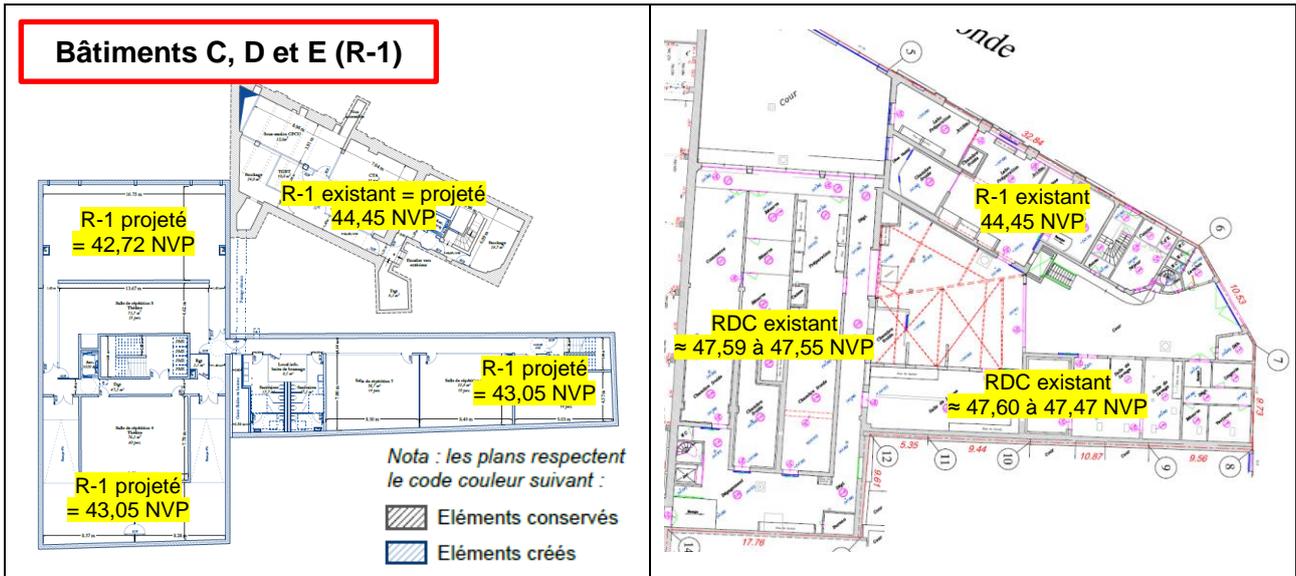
Extrait du plan du niveau R-1 des bâtiments C, D et E, daté du 17/11/2023 et extrait du plan RDC existant
